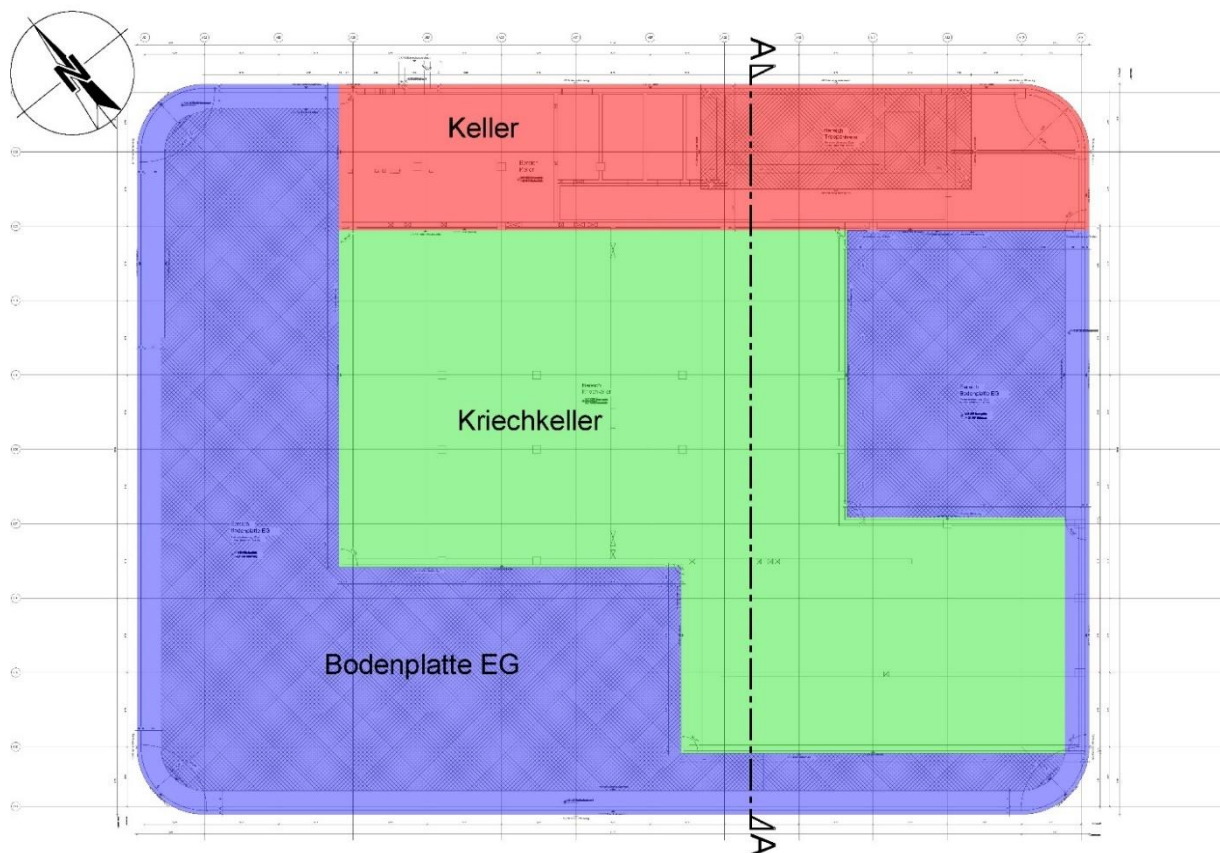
Grundriss Sporthalle [U1.18], Schnitt A-A siehe Bild 10
